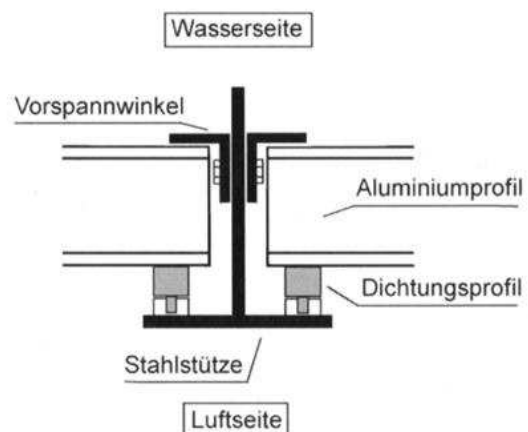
Grundriss Stütze [Patt, 2001]
